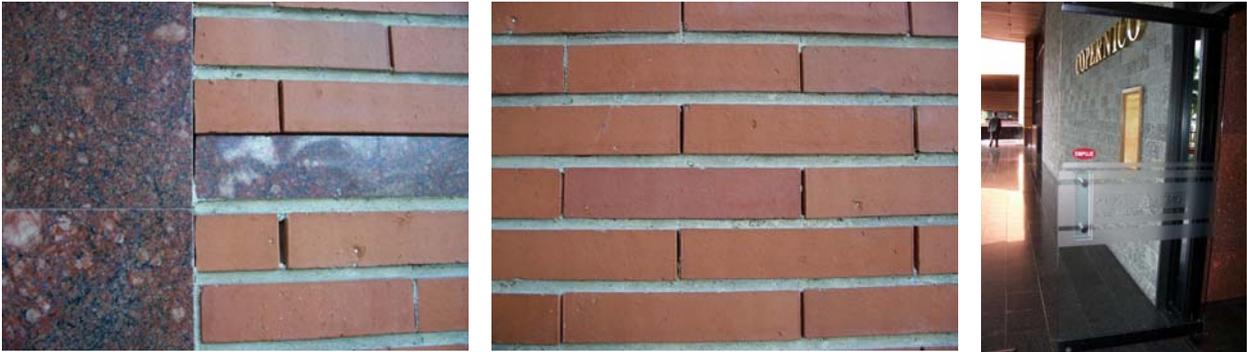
Fotos detalles revestimiento de panela de arcilla y mármol en fachadas, y vista de pavimento granito natural y piedra en pavimentos y paramentos.
